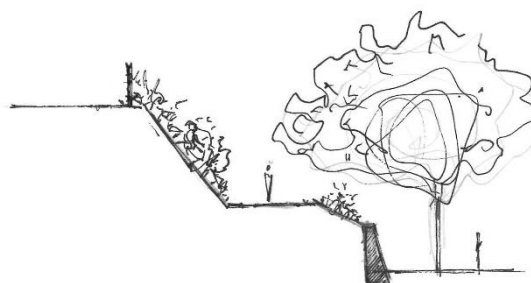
Sección de propuesta de detalle de la zona expuesta entre parcelas.
